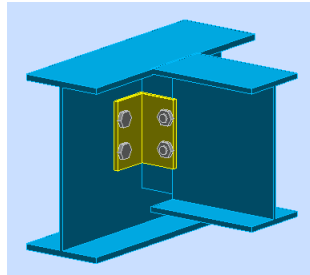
Pormenor da Ligação Viga Principal – Viga Interior (IPE 330 – IPE 270).
